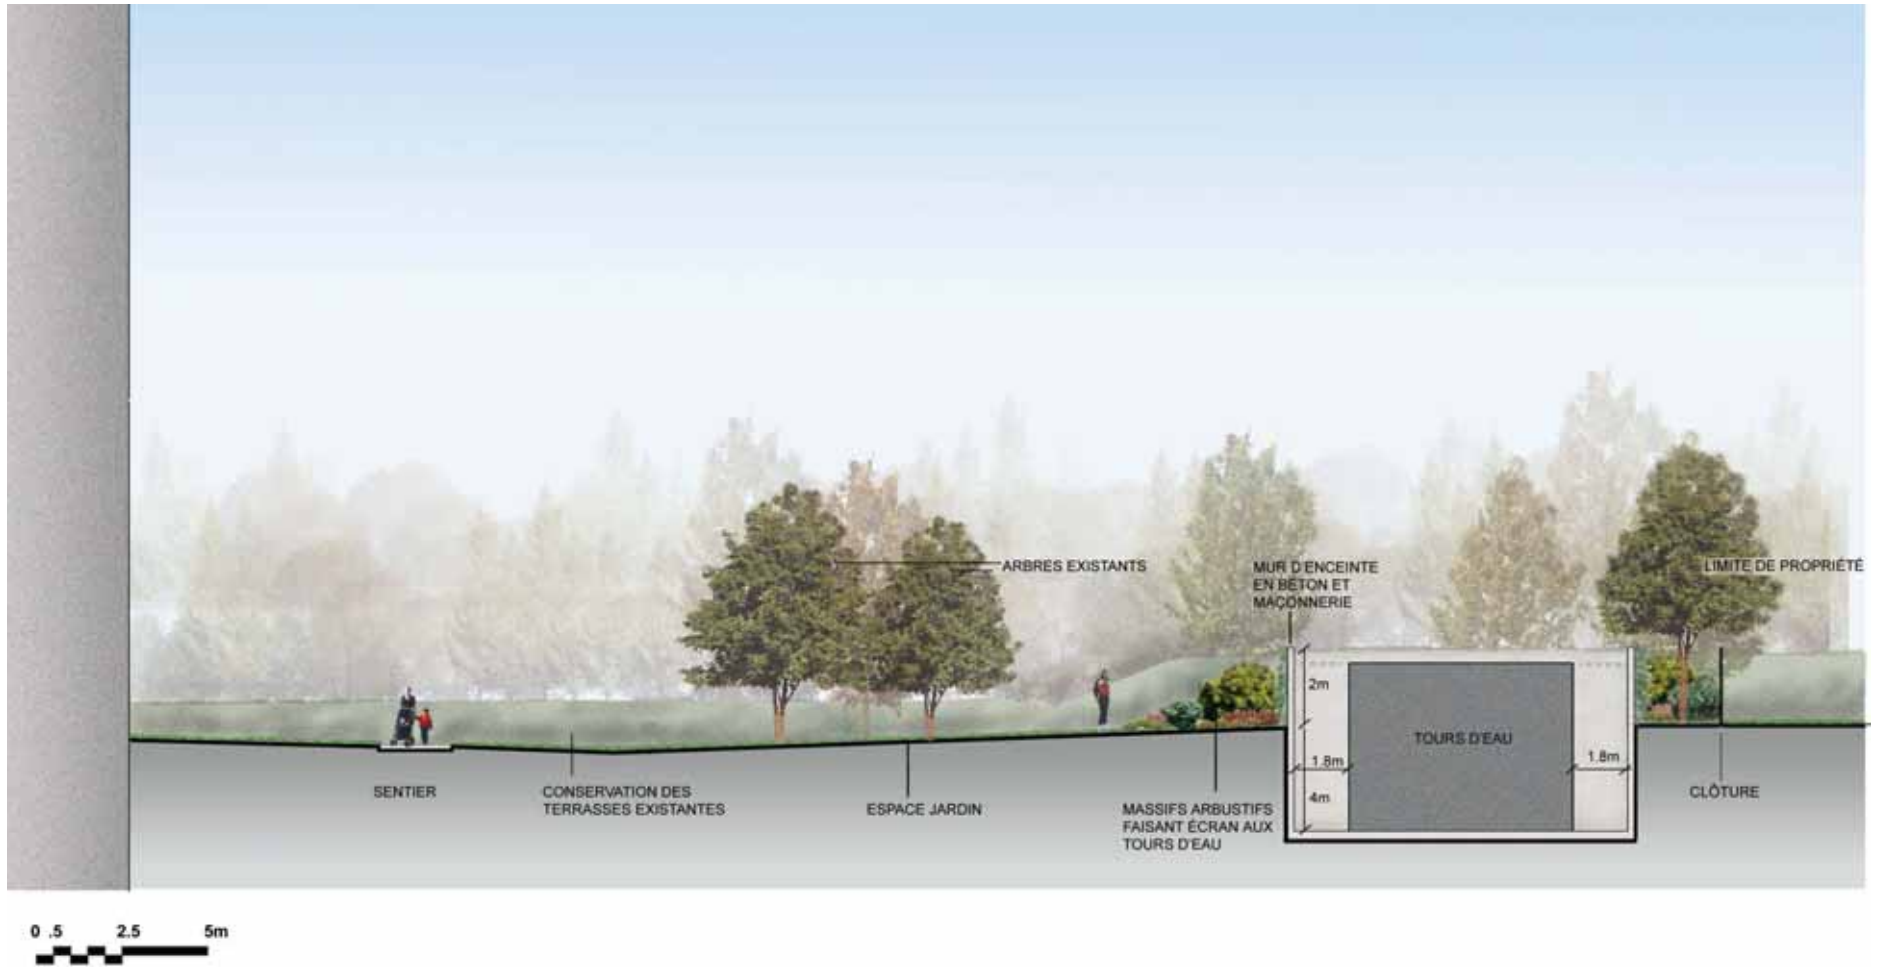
Coupe - élévation transversale DD' - Tours d'eau
